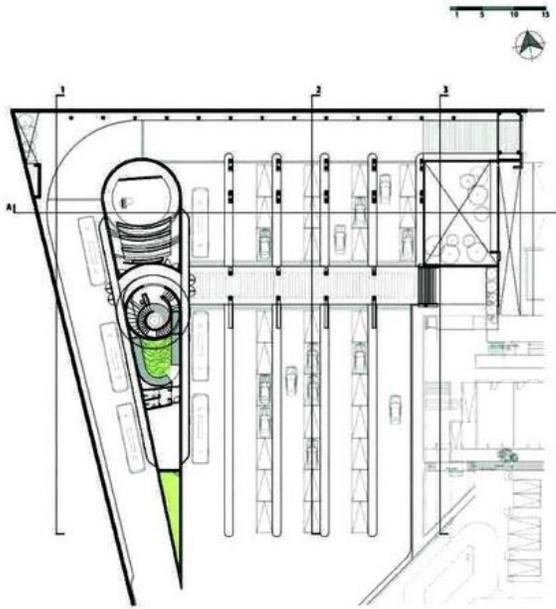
Planta arquitectónica Kinder Sinaí.
